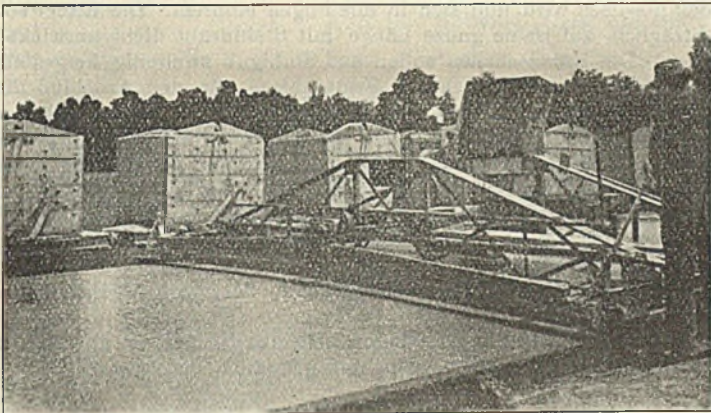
Lakewood Finishing Maschine zum Abgleichen und Dichten der Oberfläche.
